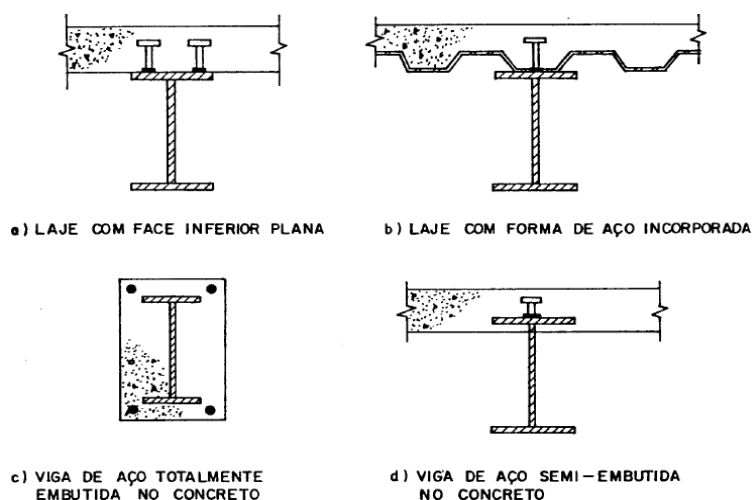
Tipos de secções de vigas mistas mais utilizadas (Malite,1990)
